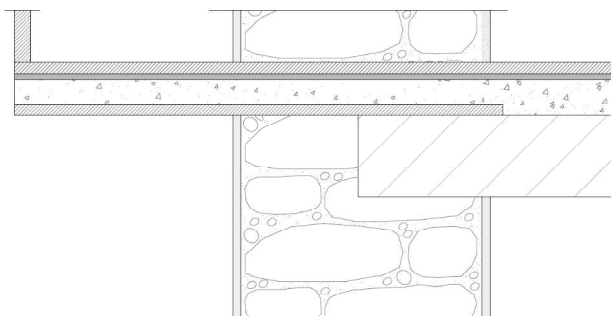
Fachada-Forjado (balcón). Zona este. Estado original.
